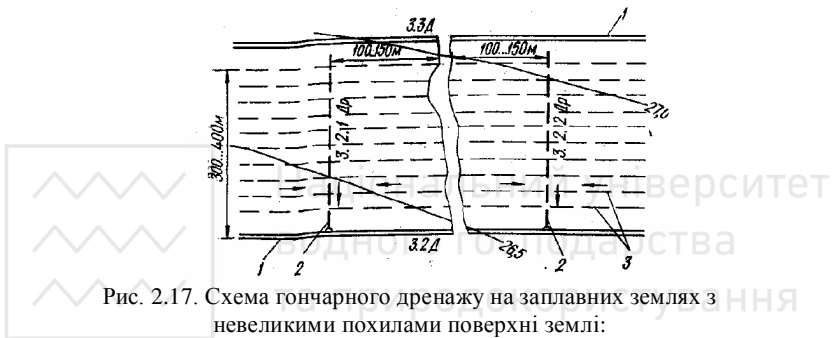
Схема гончарного дренажу на заплавах з невеликими похилами поверхні землі:
